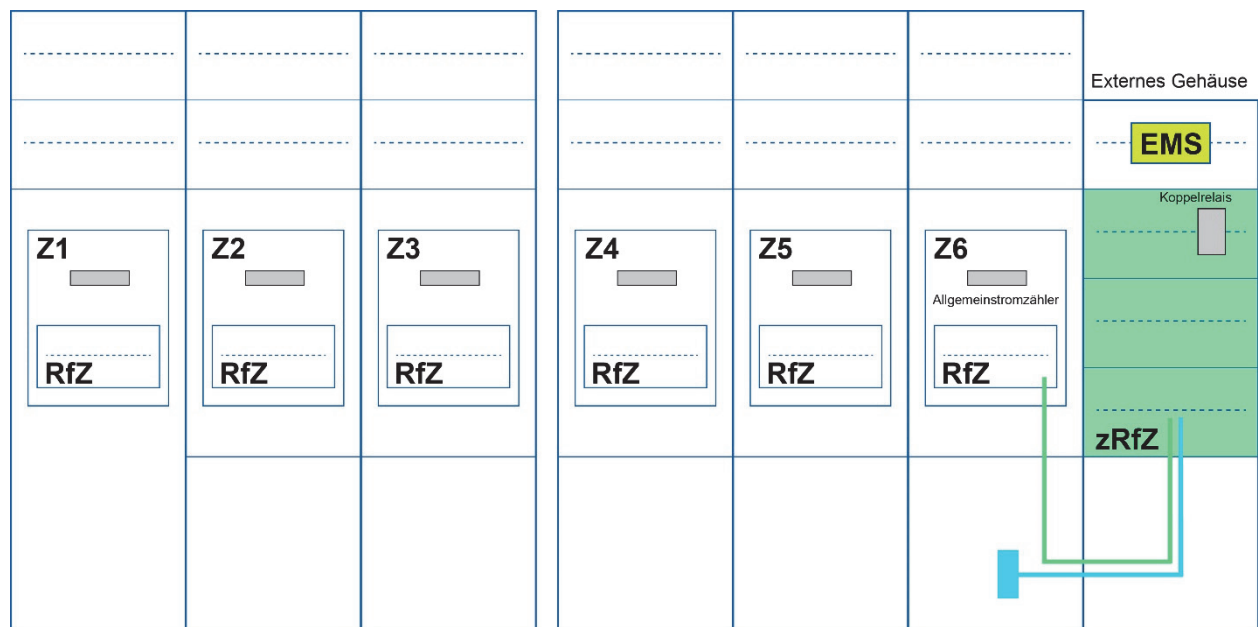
Bestandszählerplätze ohne zusätzlichen Zählerplatz bzw. Steuergerätefeld
